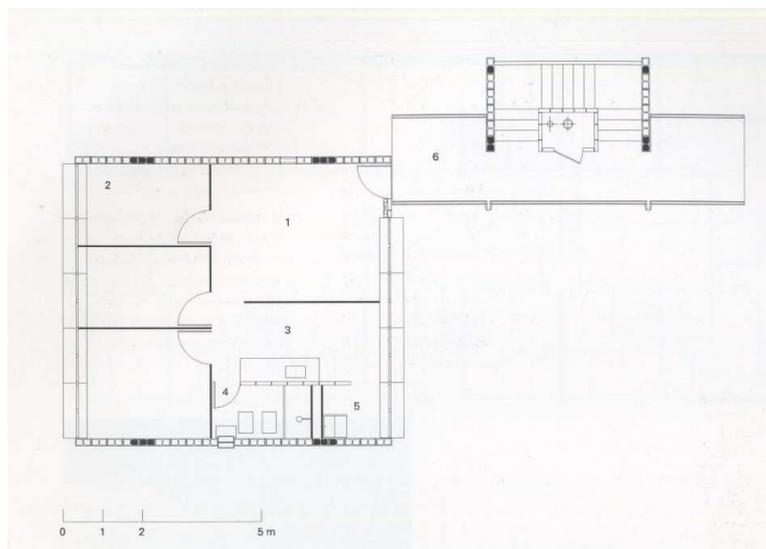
Planta unidad 1ª etapa (Fuente: <sup>21</sup>)
